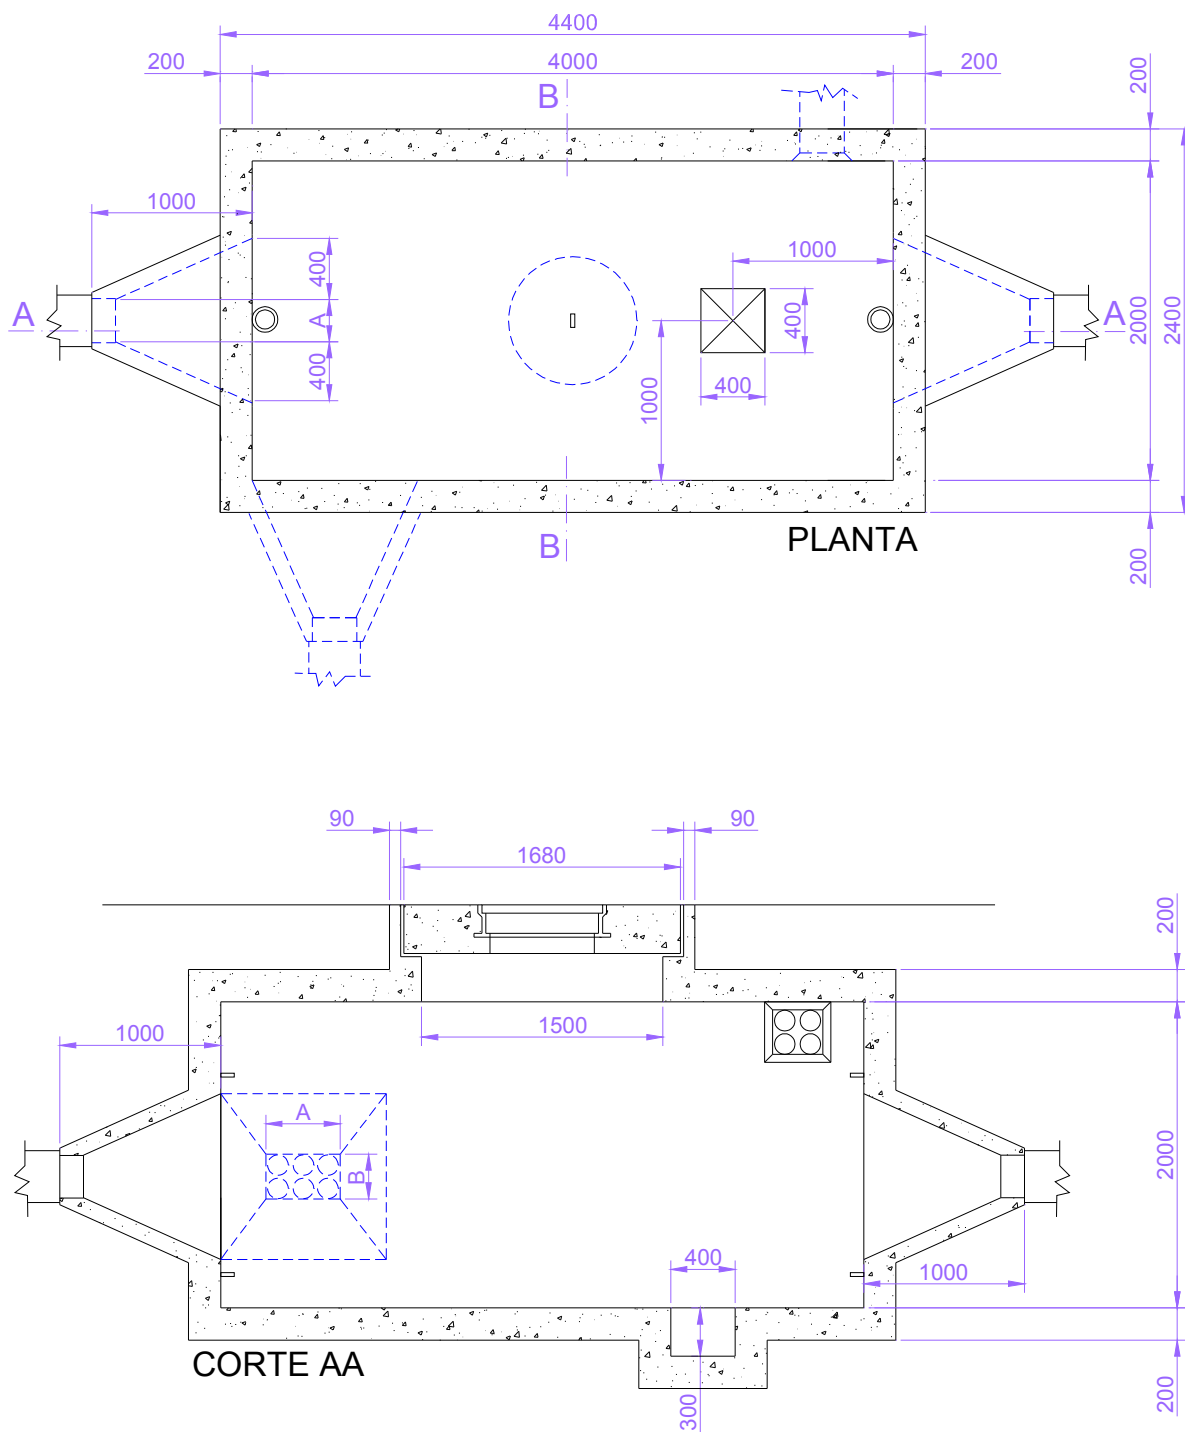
Caixas de inspeção modificada tipo CI-1M (2,00 m x 2,00 m x 2,00 m)
